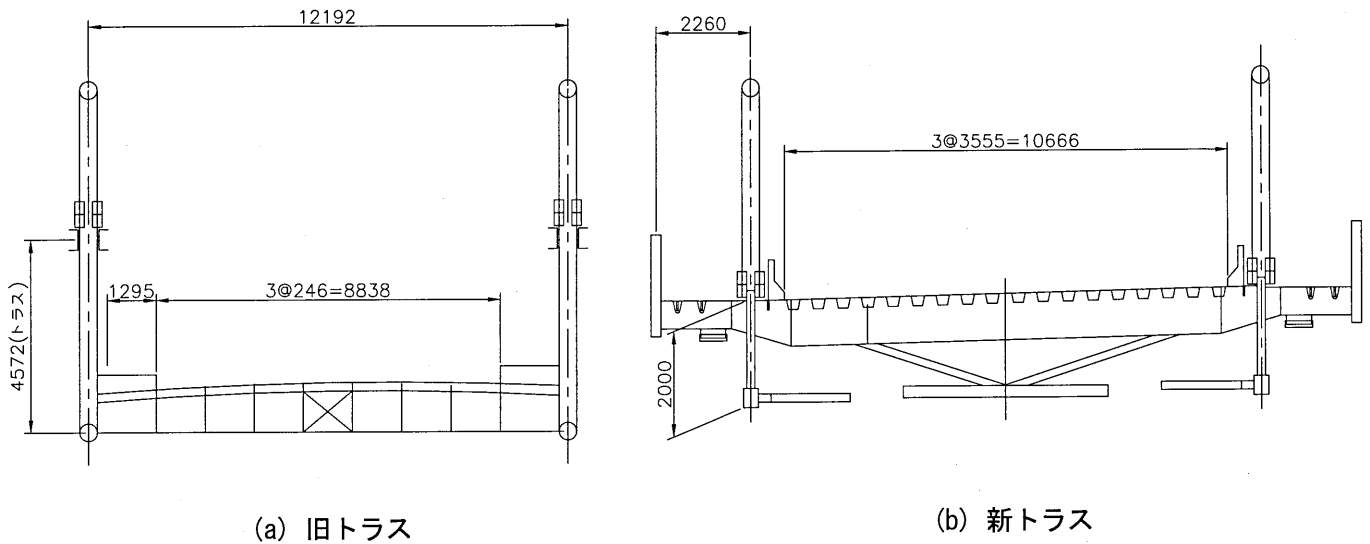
床版および補剛トラス図(寸法単位: mm)
